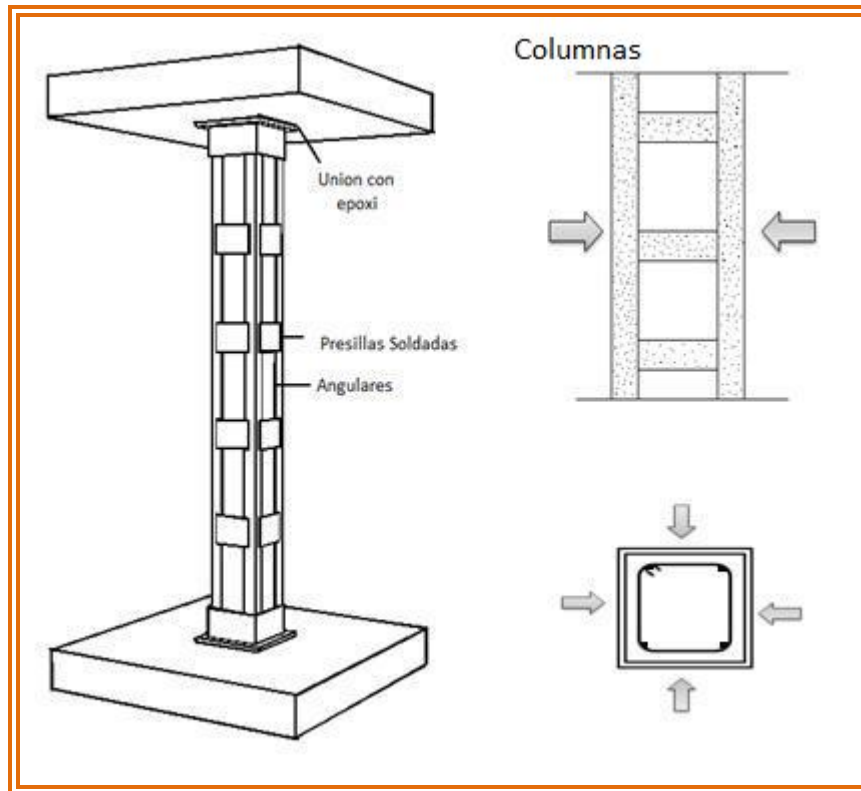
Refuerzo de columnas con perfiles metálicos.
